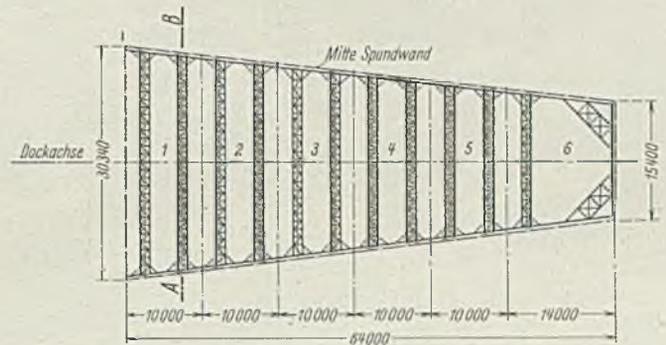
Spundwandaussteifung in der Baugrube der Dockverlängerung mittels eiserner Gitterstützen.
